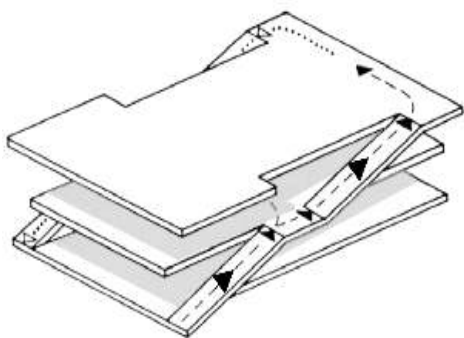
Rampa reta de pista simples com subida e descida (adaptado de Klose, Dietrich – Parkhäuser und Tiefgaragen)
